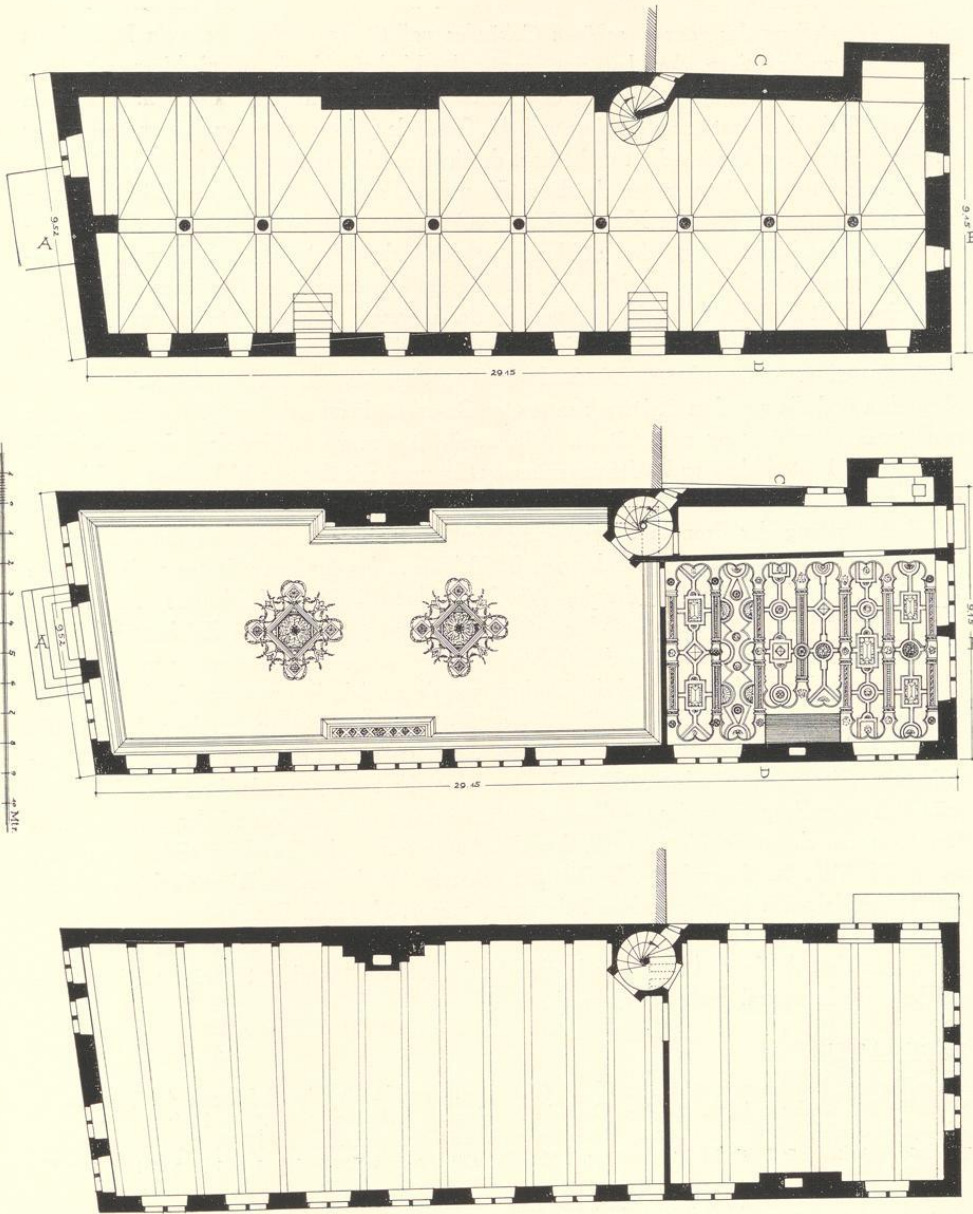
821. Grundriß des Kellergeschosses, Erd- und Obergeschosses des Krameramtshaus. Nordosten rechts
